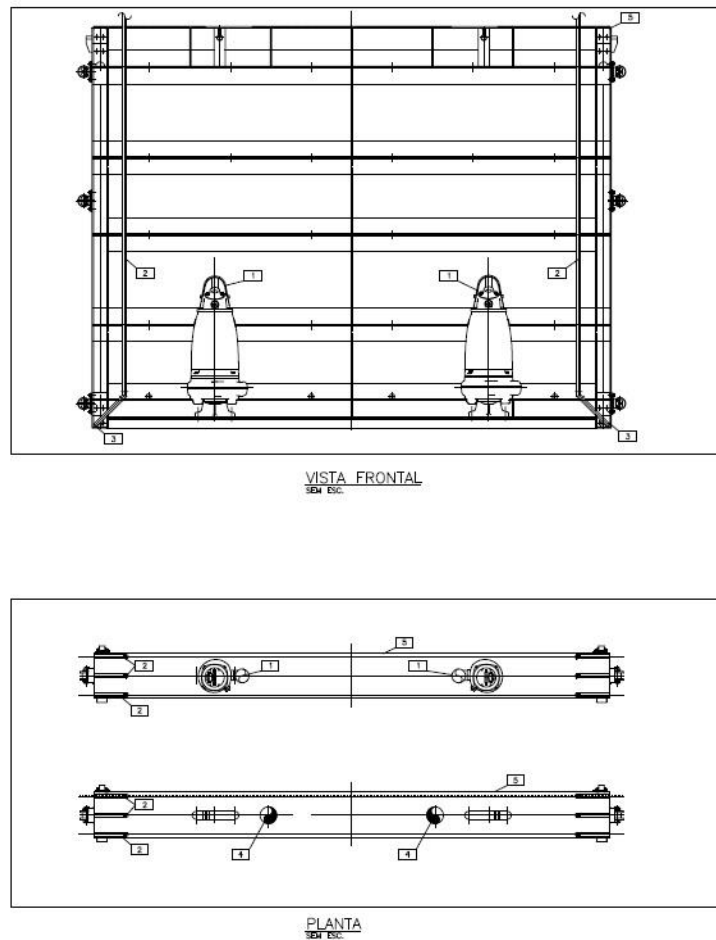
Planta e vista Frontal – Gabarito para Bombeamento
